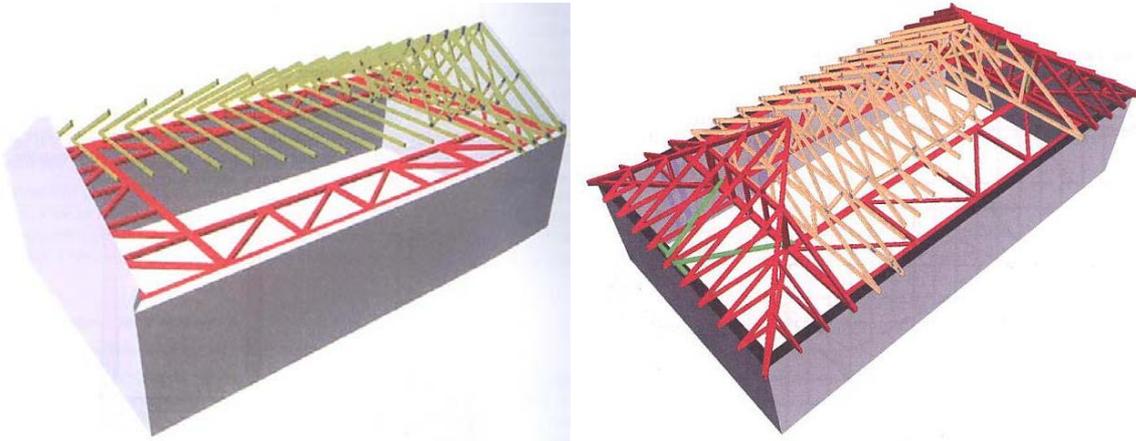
Contreventement d'une toiture à fermettes sous entrain. A gauche, toiture à 2 pentes. A droite, toiture à 4 pentes. Document AFPS
